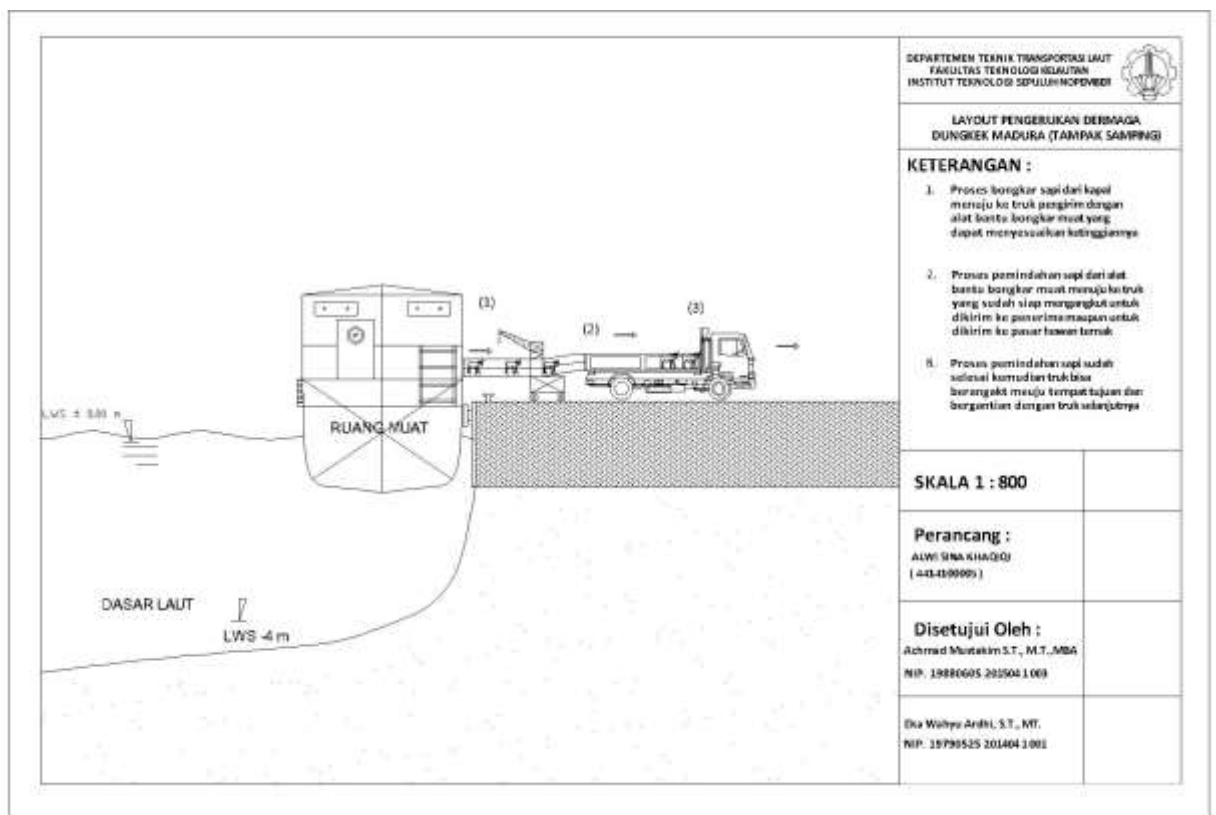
Pengembangan Dermaga Beton Tampak Samping
